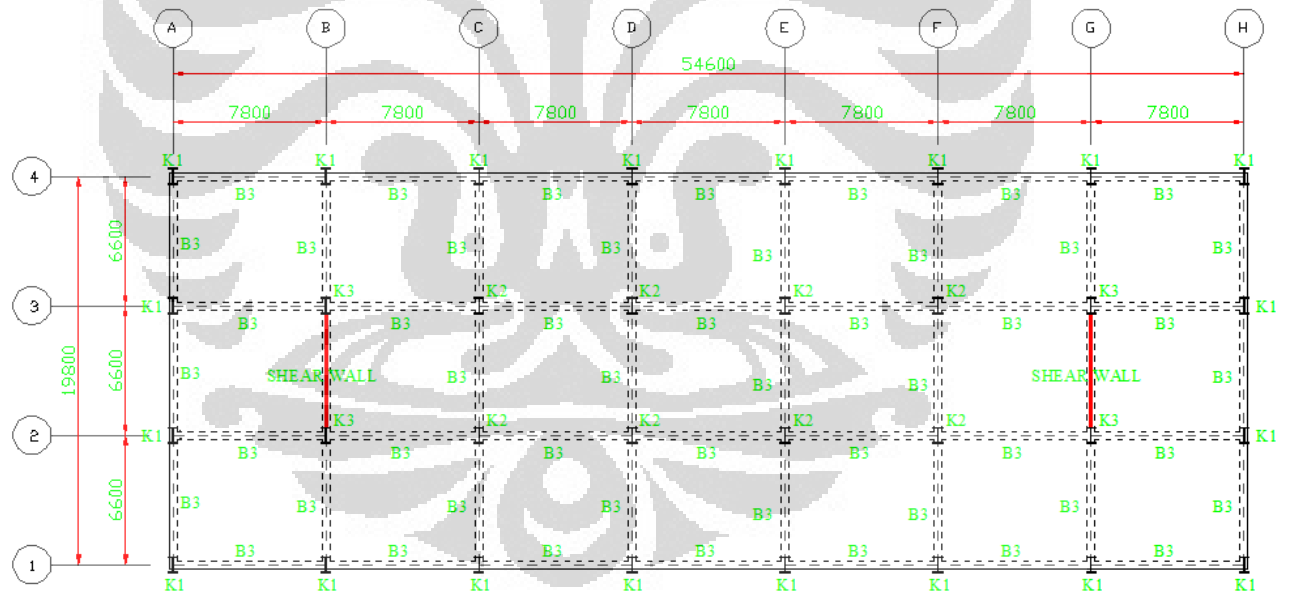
Denah Struktur Baja Lantai 1-4
